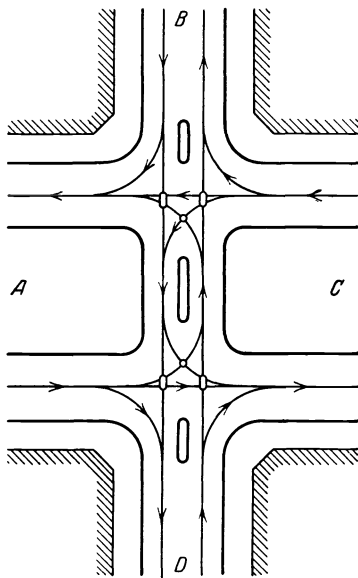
Straße mit Mittelpromenade, Einbahnstraßen.
